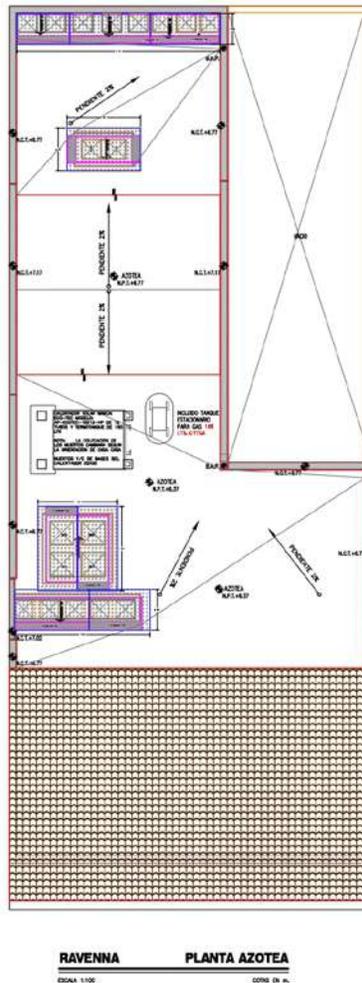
Distribución de planta de azotea en prototipo “Ravenna” (AIVIA Conceptos Inmobiliarios, 2021)
